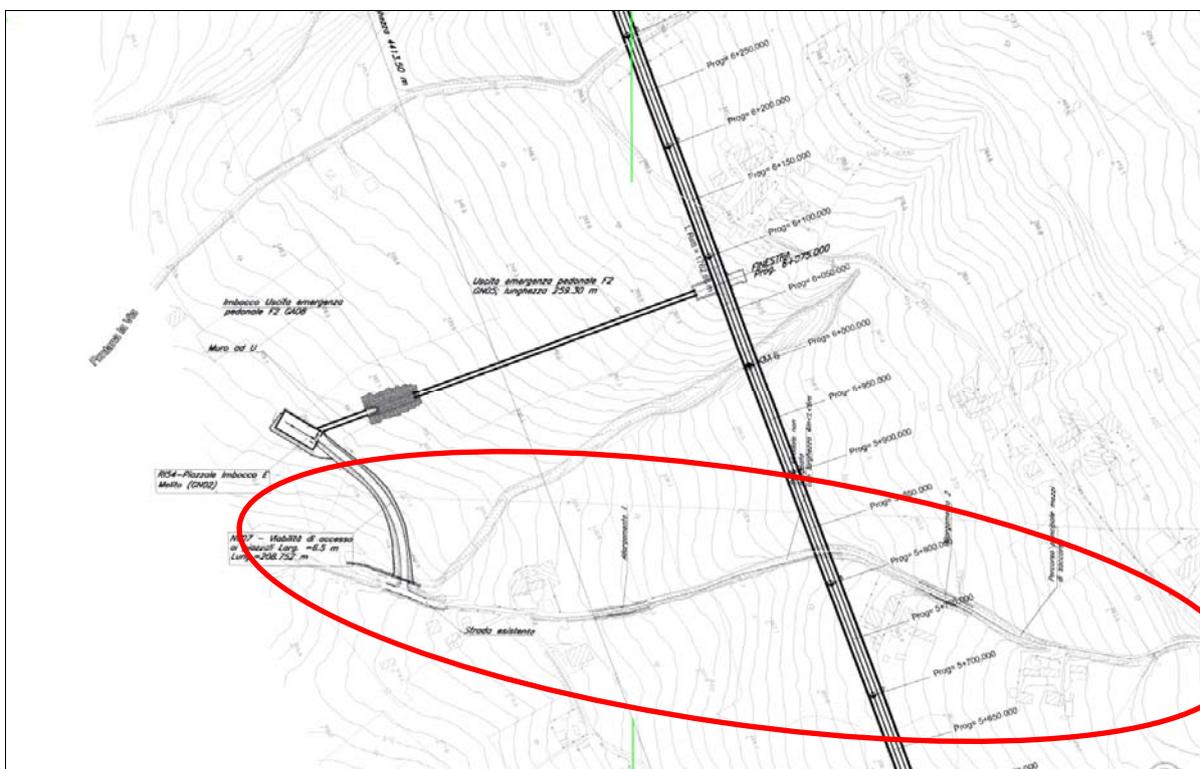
Stralcio planimetrico con l'individuazione dell'intervento
